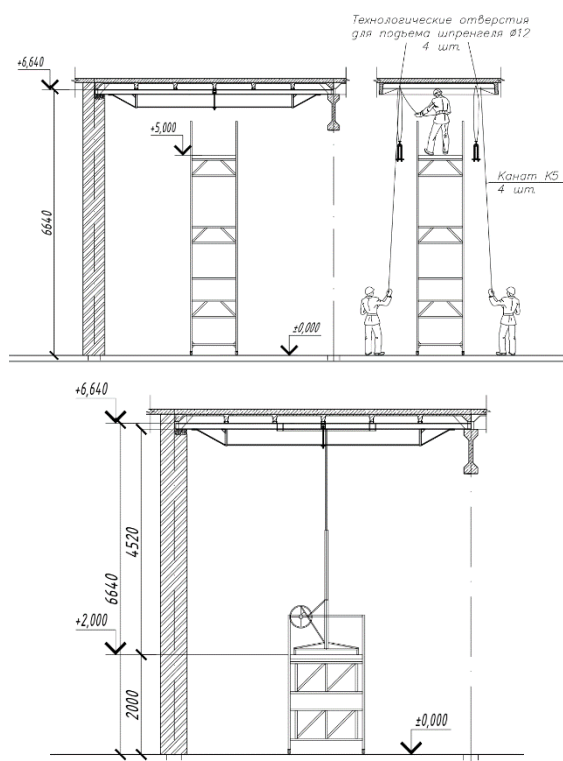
Рассмотренные организационно-технологические схемы монтажа подкладочной стальной балки-шпренгеля под усиливаемой ребристой плитой покрытия
